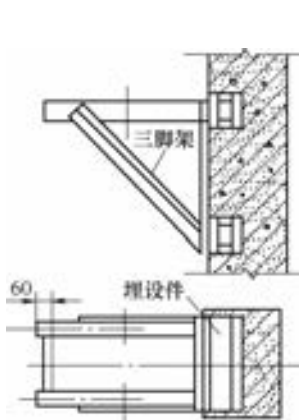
A 式通风机在钢筋混凝土上的安装支架
